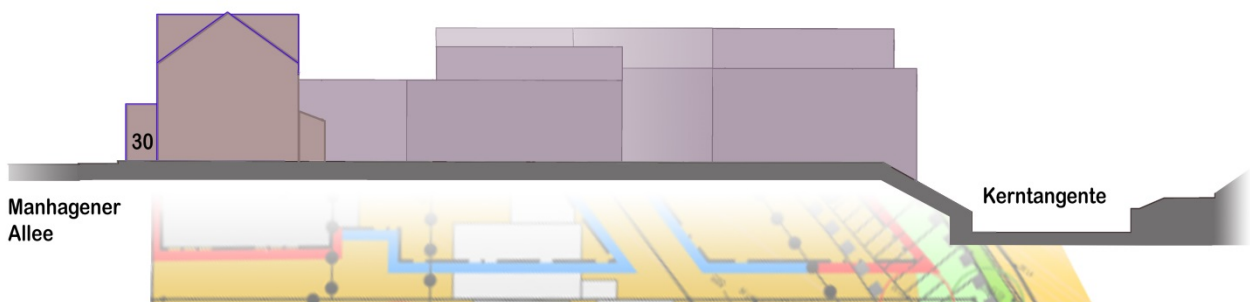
Schnittzeichnung durch das Plangebiet mit Beispiel möglicher Neubebauung
